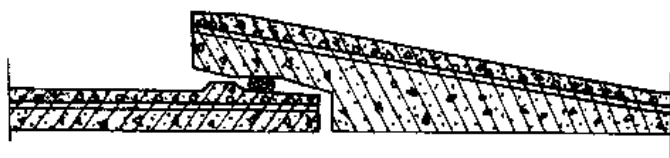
一阶段工艺钢筋混凝土管道柔性接口
